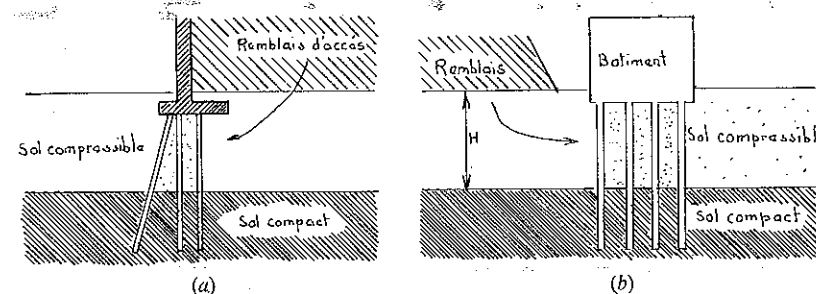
Poussées horizontales provoquées par un remblai construit sur sol compressible.
